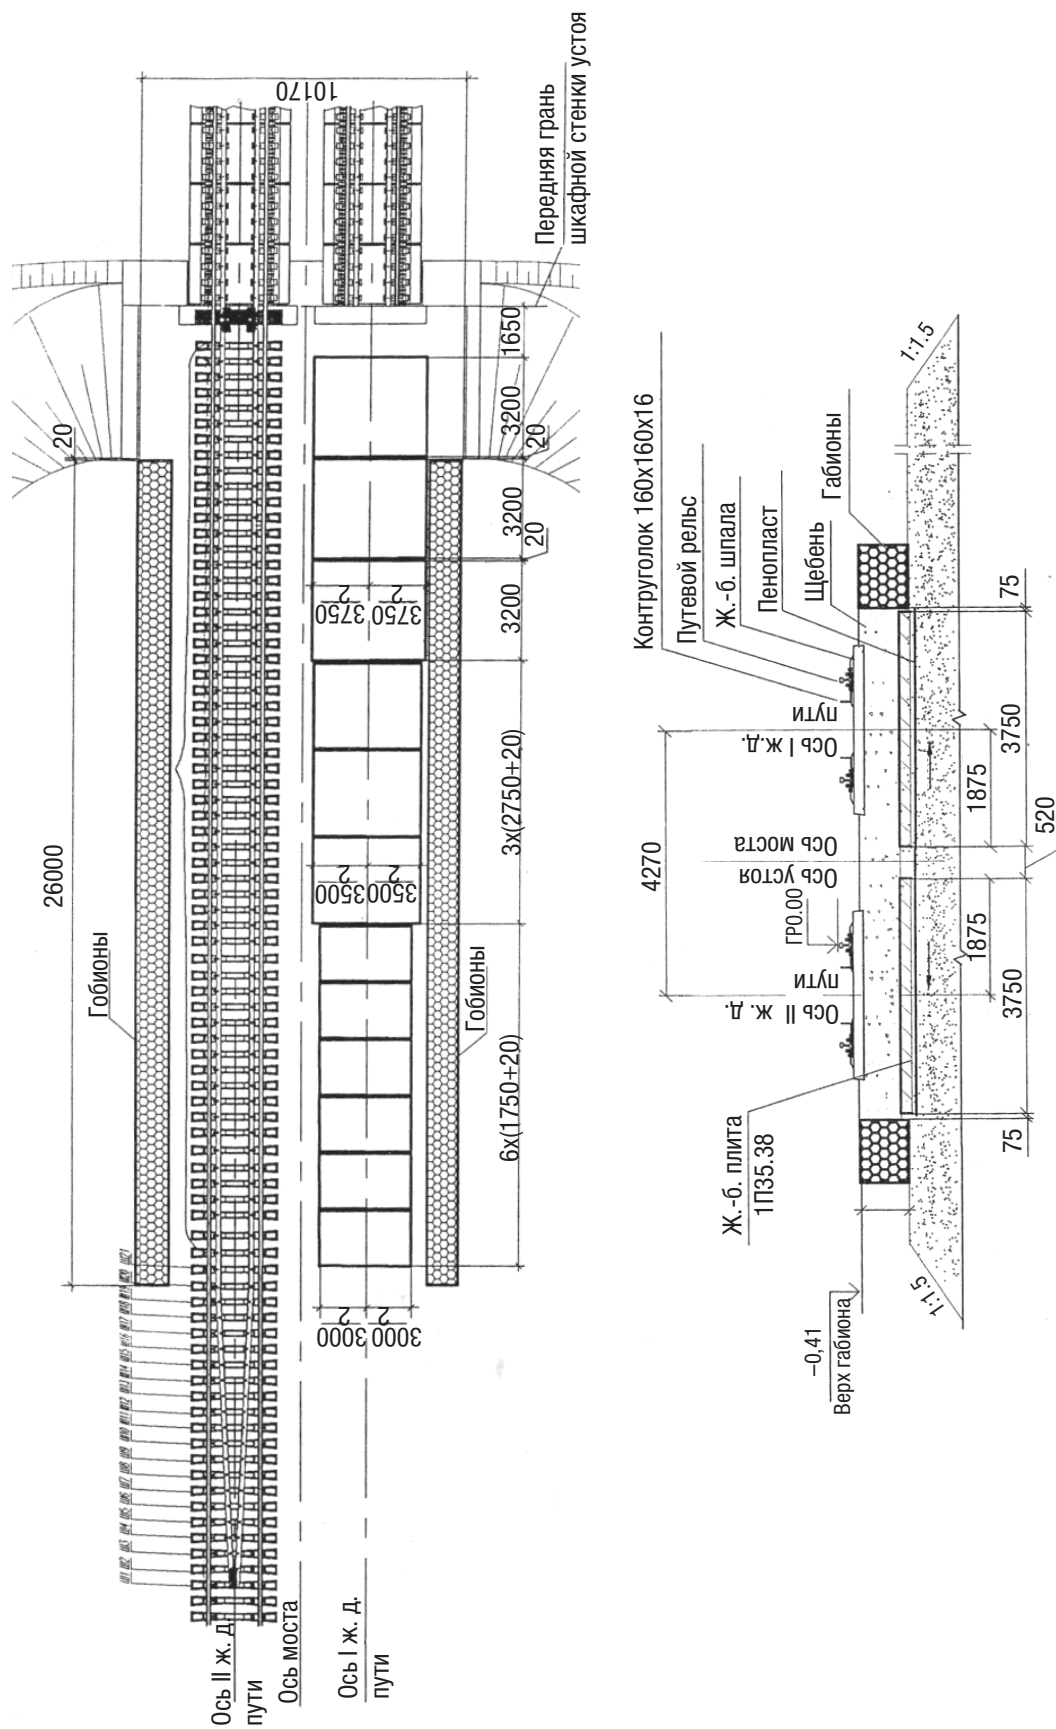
Конструкция переменной жесткости с железобетонными плитами [2]
